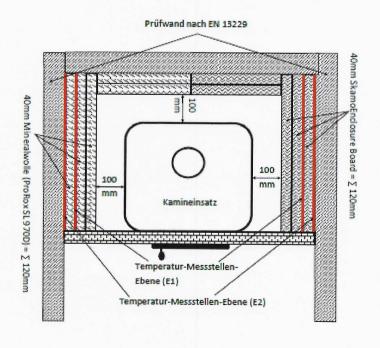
Draufsicht-Schnitt: Prüfaufbau Versuchstag 2: 120 mm SkamoEnclosure Board und 120 mm Mineralwolle
